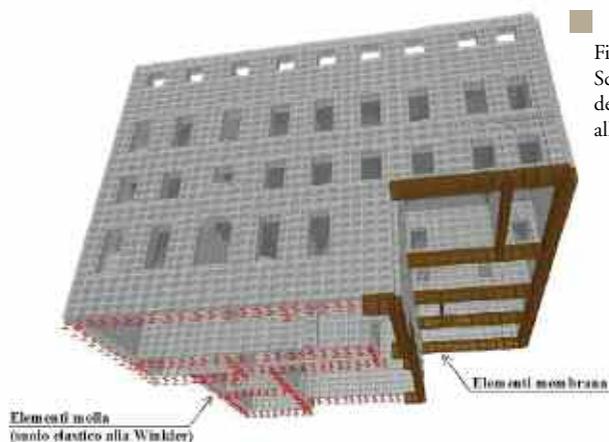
Schematizzazione del suolo di fondazione all'interno del modello.
